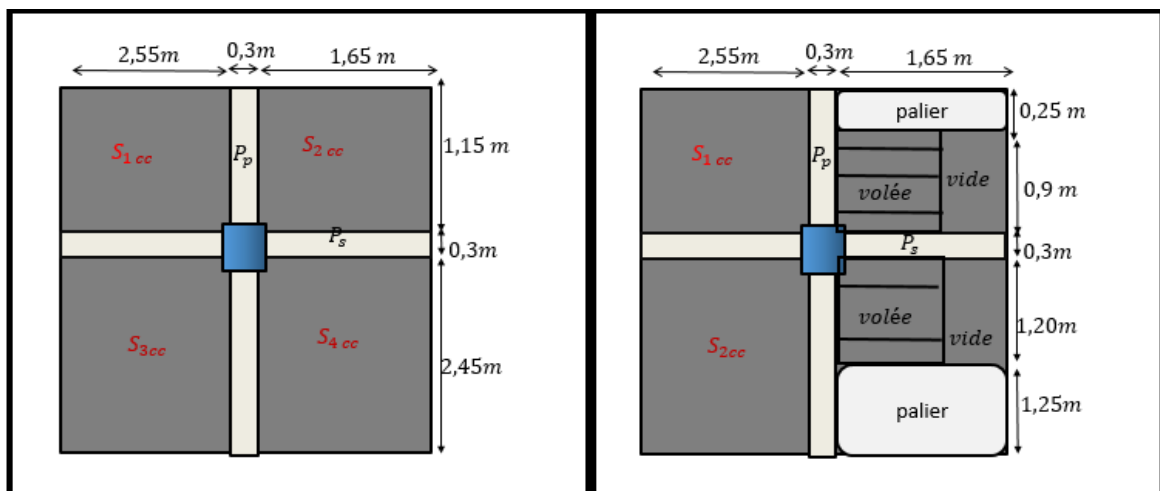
Poteau « P₂ » de la descente de charge étage courant et terrasse inaccessible d'une manière semblable au calcul précédent on trouve les résultats pour le poteau 2
